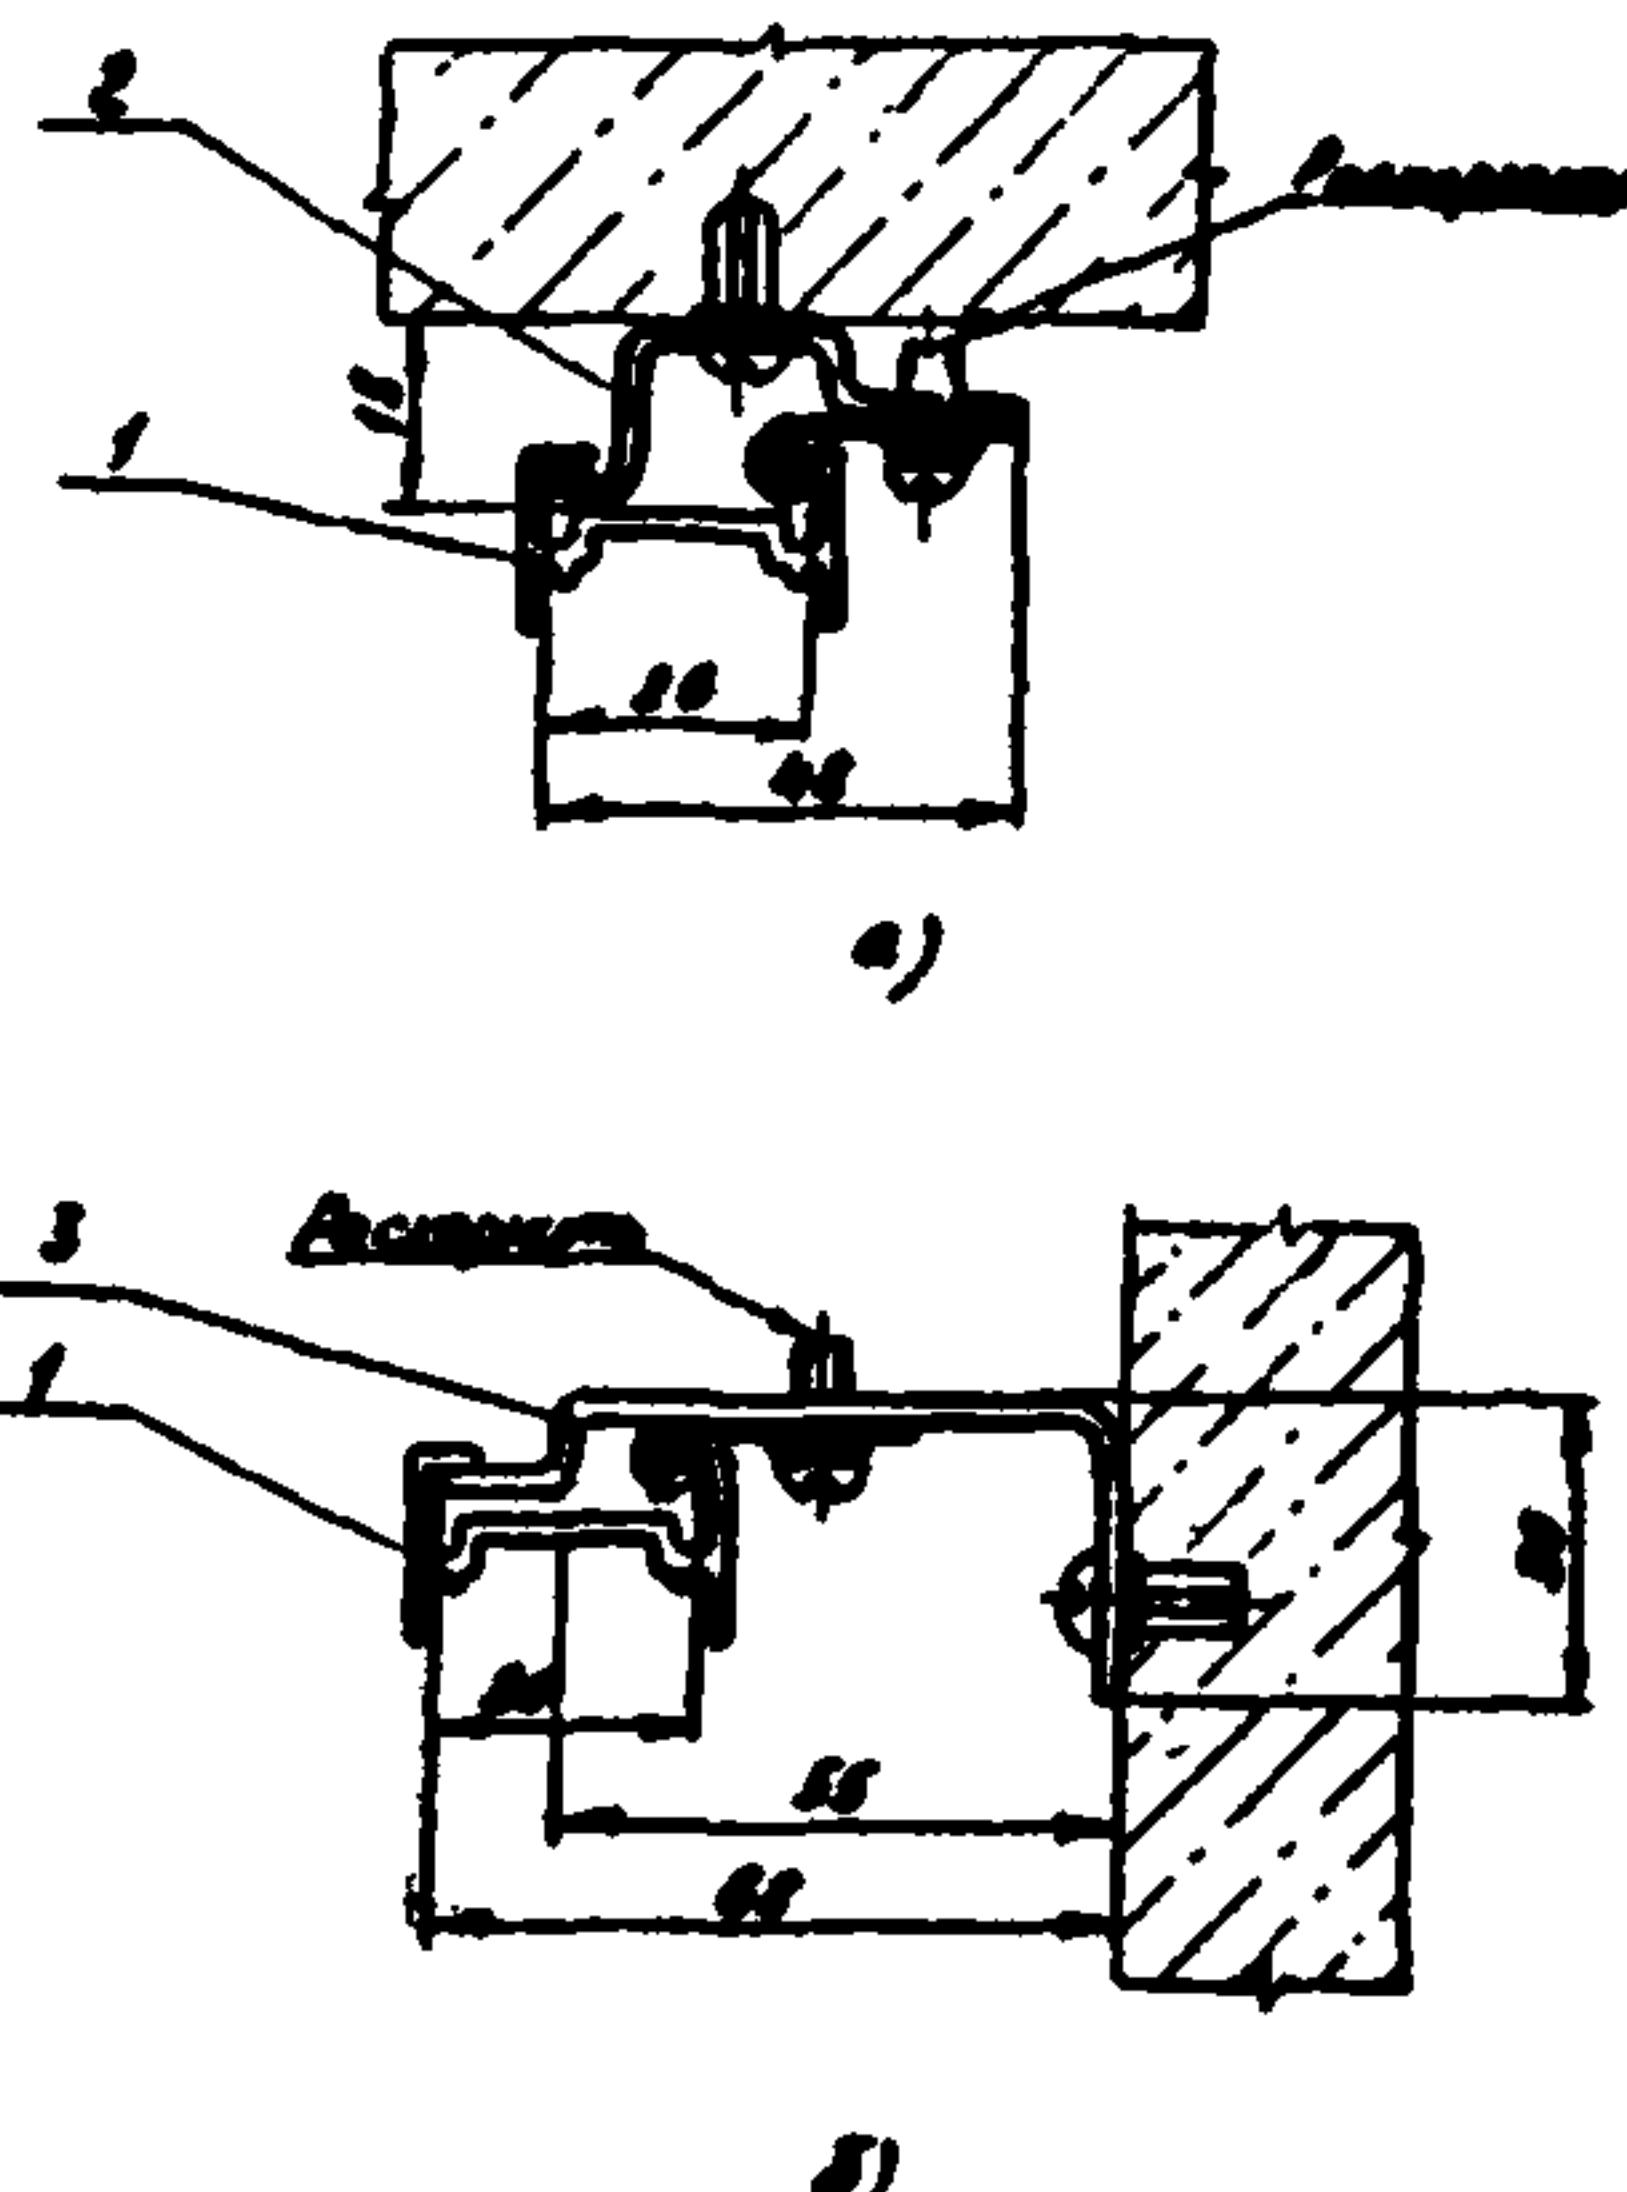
Конструкции для крепления осветительного шинопровода ШОС80 на потолке (а) и на стене (б): 1 - шинопровод; 2 - закреп потолочный У1925; 3 - кронштейн настенный У1924.
